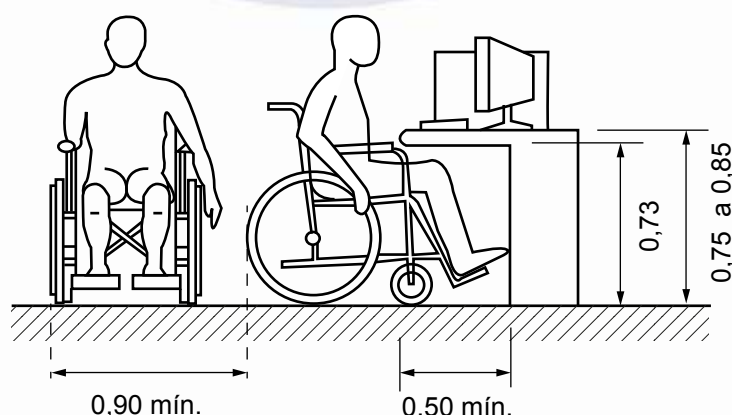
Terminais de consulta – Exemplo – Vista lateral
